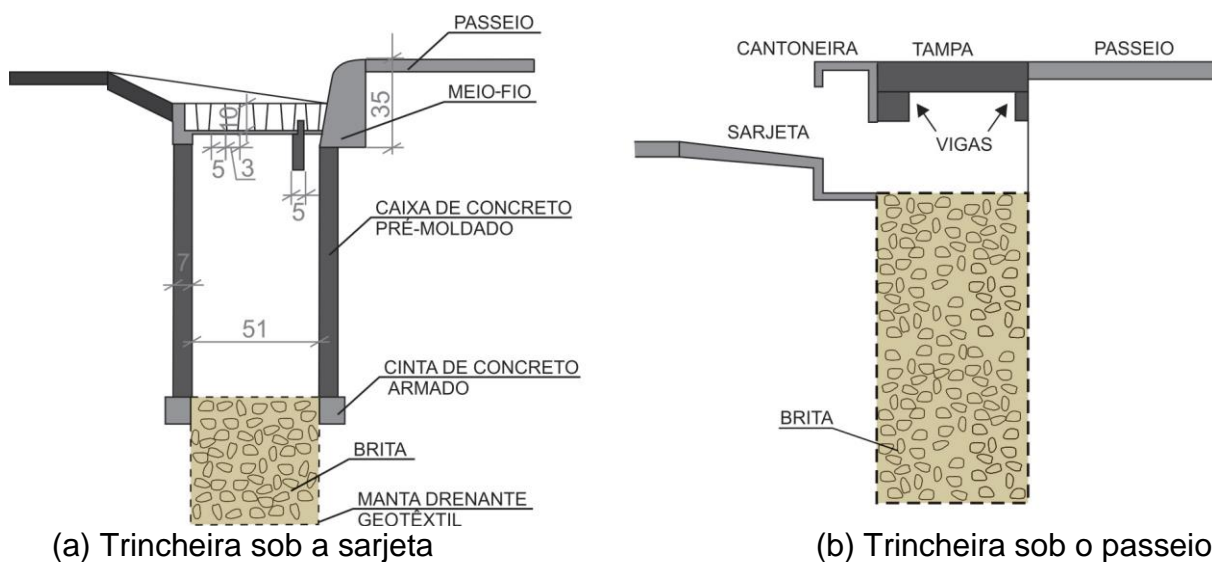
Trincheira de infiltração sob a sarjeta (a) e sob o passeio (b).
